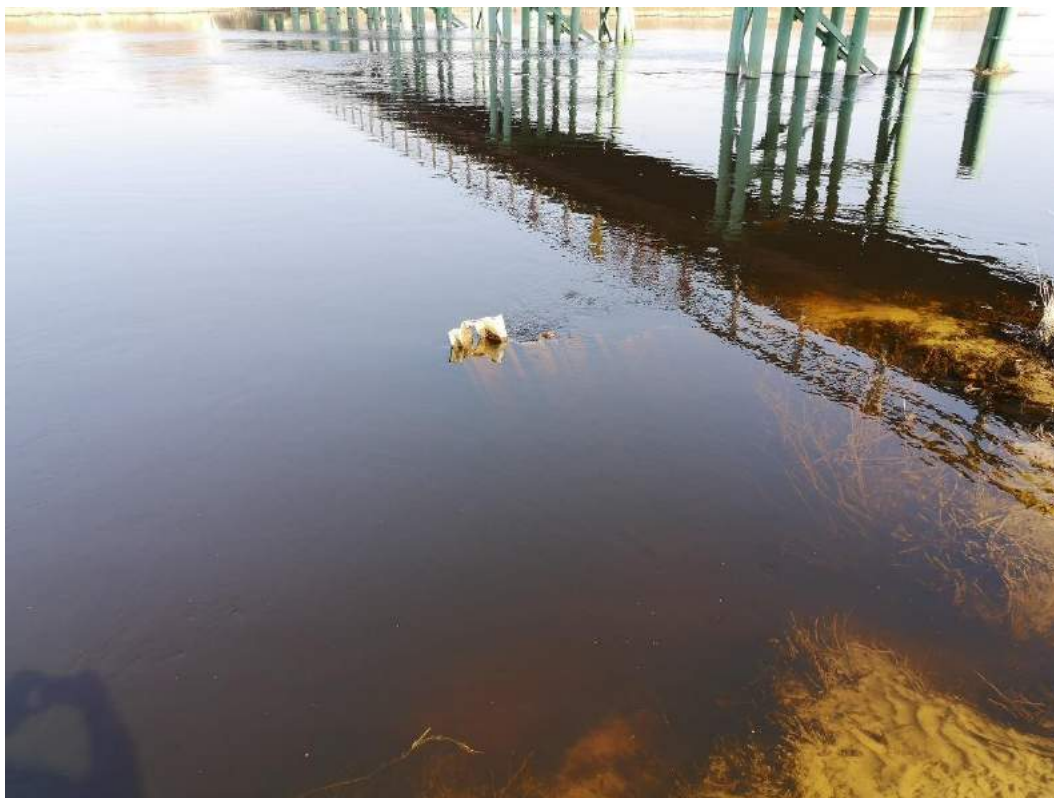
Widok na przyczółek nr 1 – od strony lewego brzegu
